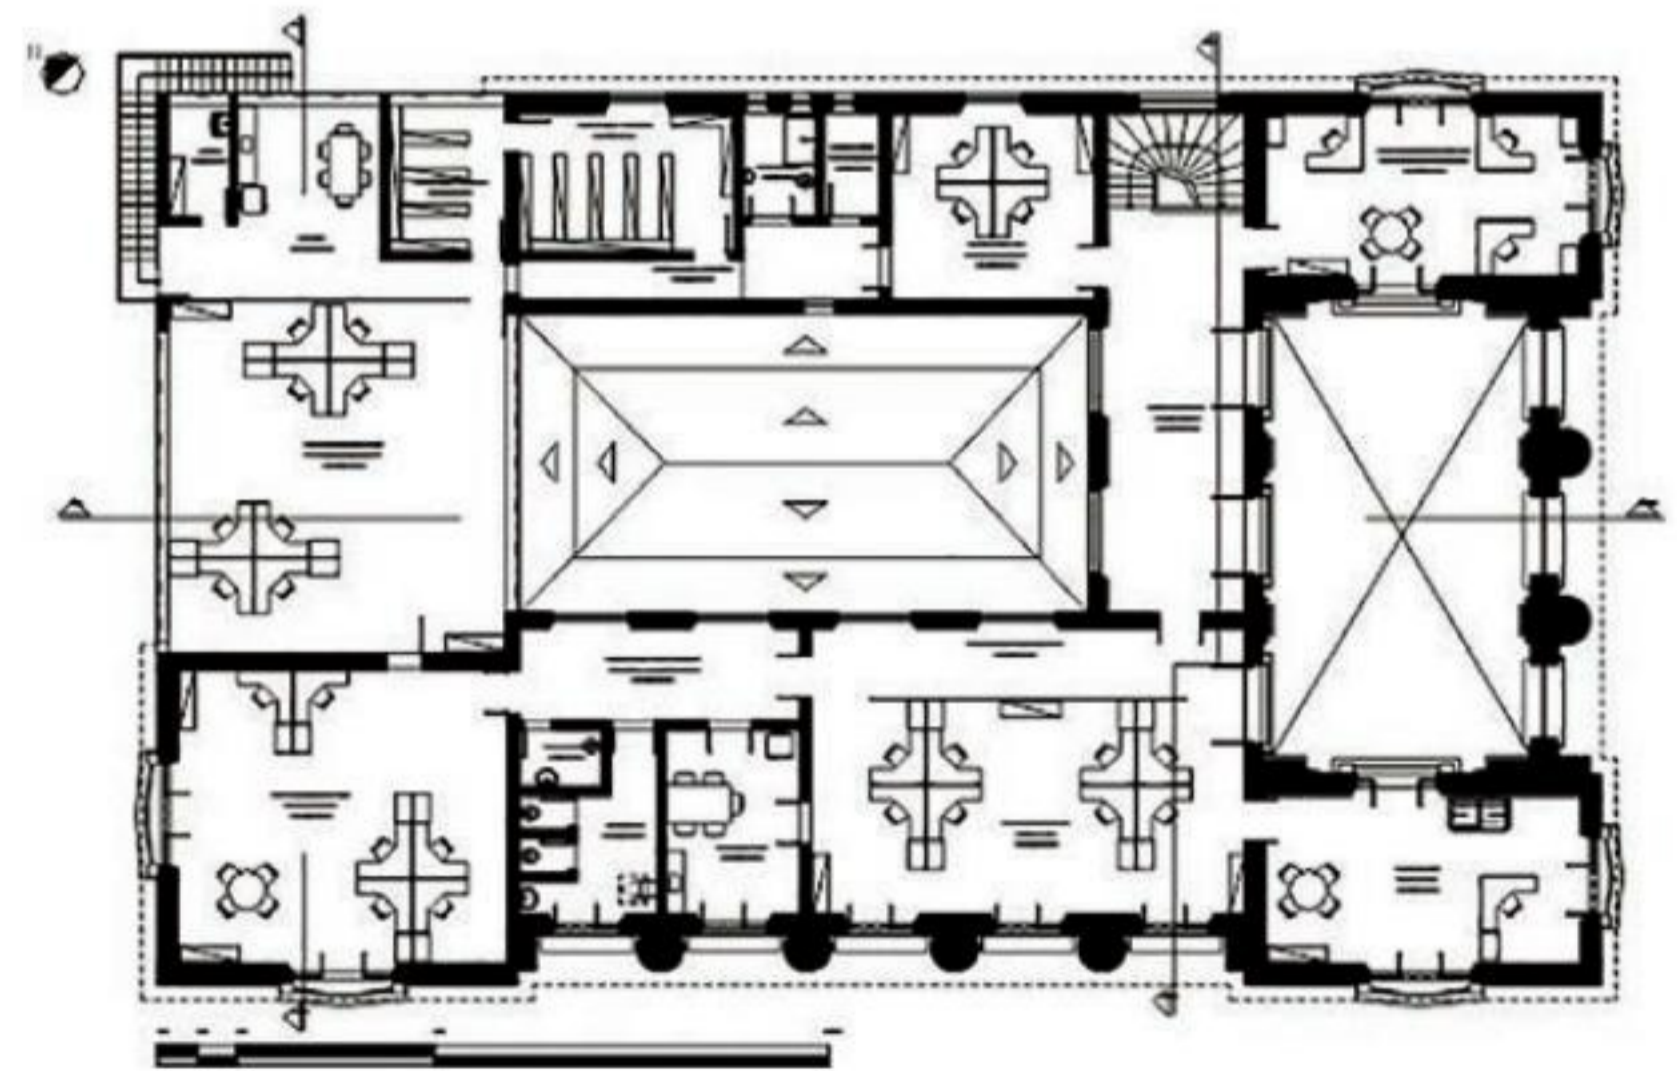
Proposta de intervenção – planta 2º pavimento. Ver MACHADO (2007).
